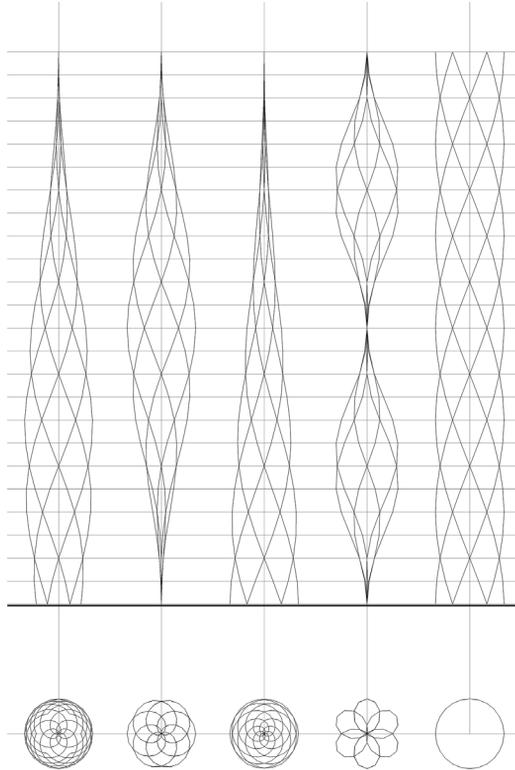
Torre espiral con crecimiento sinusoidal, vista en planta y en alzado.
